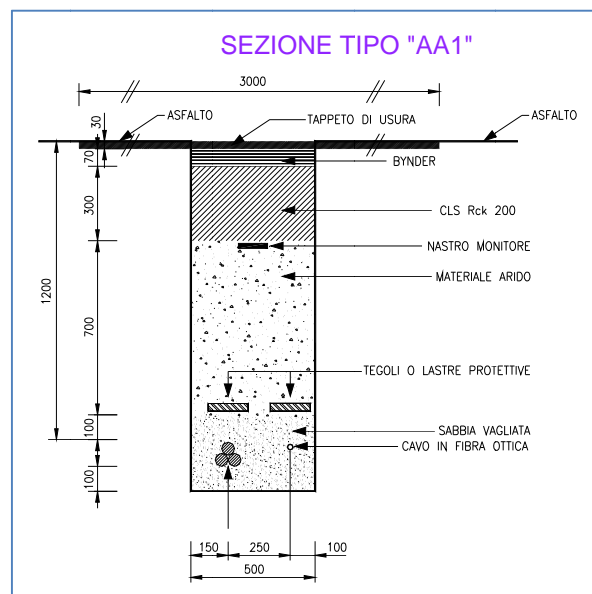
Sezione tipica di posa della linea in cavo su sede stradale
